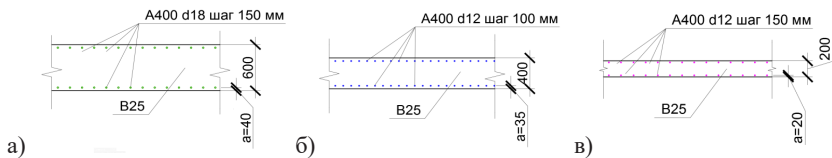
Конструкция фундаментных плит и плит перекрытия в расчетных схемах: а) – фундаментная плита 600 мм:  $k_1 = 0,127$ ; б) – фундаментная плита 400 мм:  $k_1 = 0,141$ ; в) – плита перекрытия 200 мм,  $k_1 = 0,163$ ,  $k_2 = 0,144$ ,  $E_{eq} = 4056461$  кПа,  $h_{eq} = 0,212$  м
